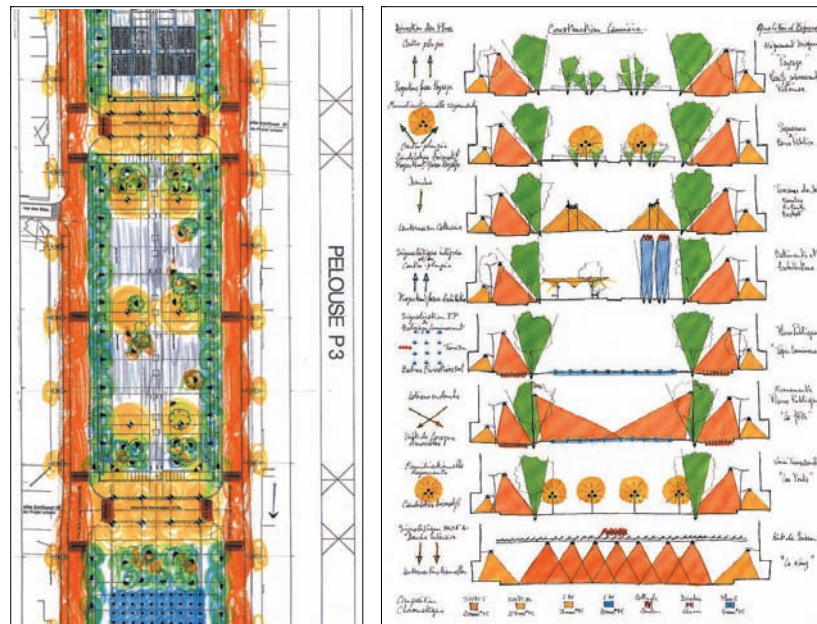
Dessin des implantations -complémentarité entre coupe et plan (LEA/avenue Wilson -détails-)
